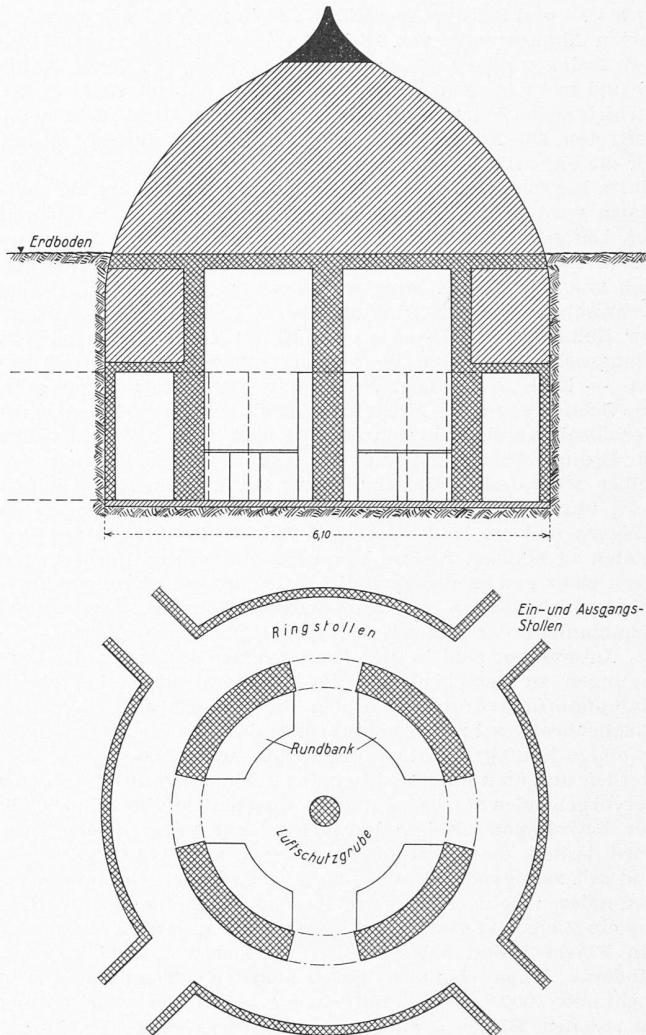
Außenanlage mit Vollbetonglocke, vertiefter Luftschutzgrube, Ringstollen, vier Ein- und Ausstiegsschachten
